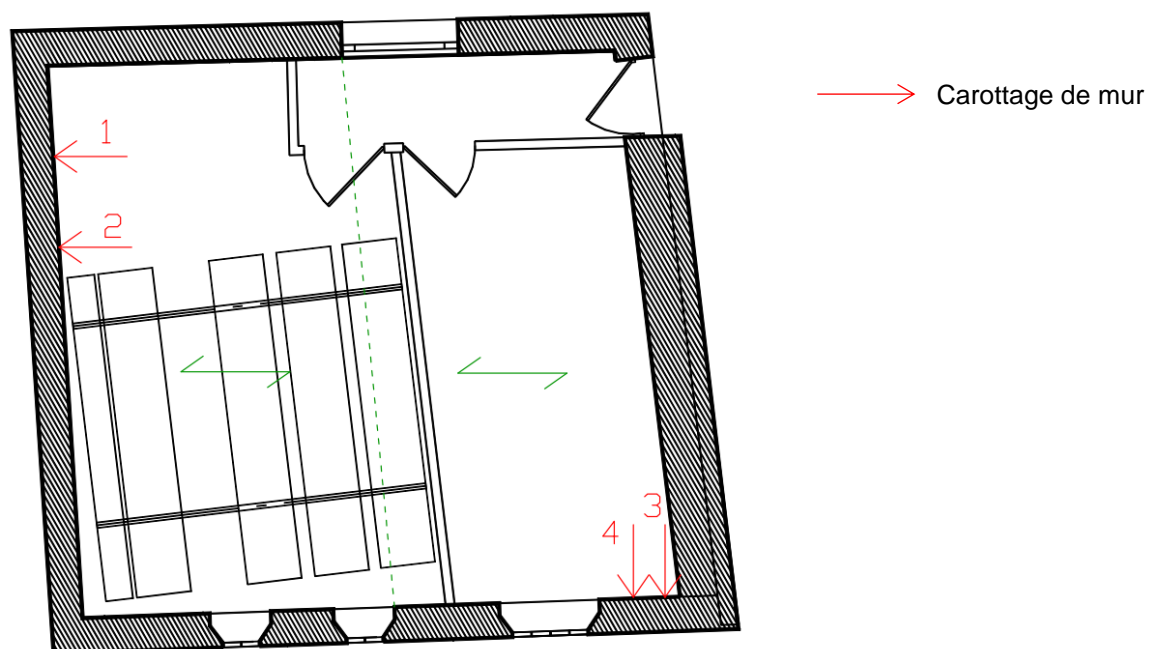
Implantation et repérage des carottages de murs du bâtiment archives
